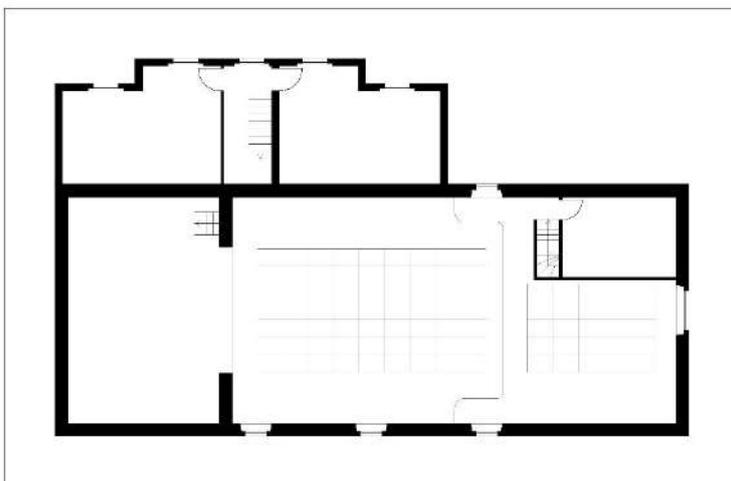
Ipotesi dell'edificio al 1939. Pianta Piano Primo
